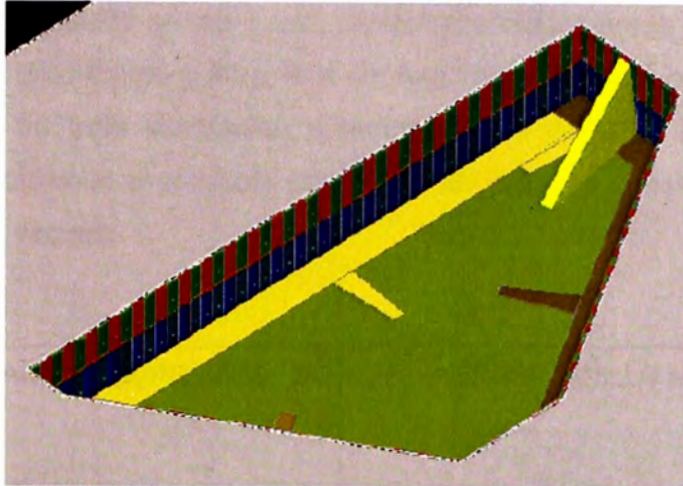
Vistas de Modelamiento en 3D en construcción de muros pantalla
